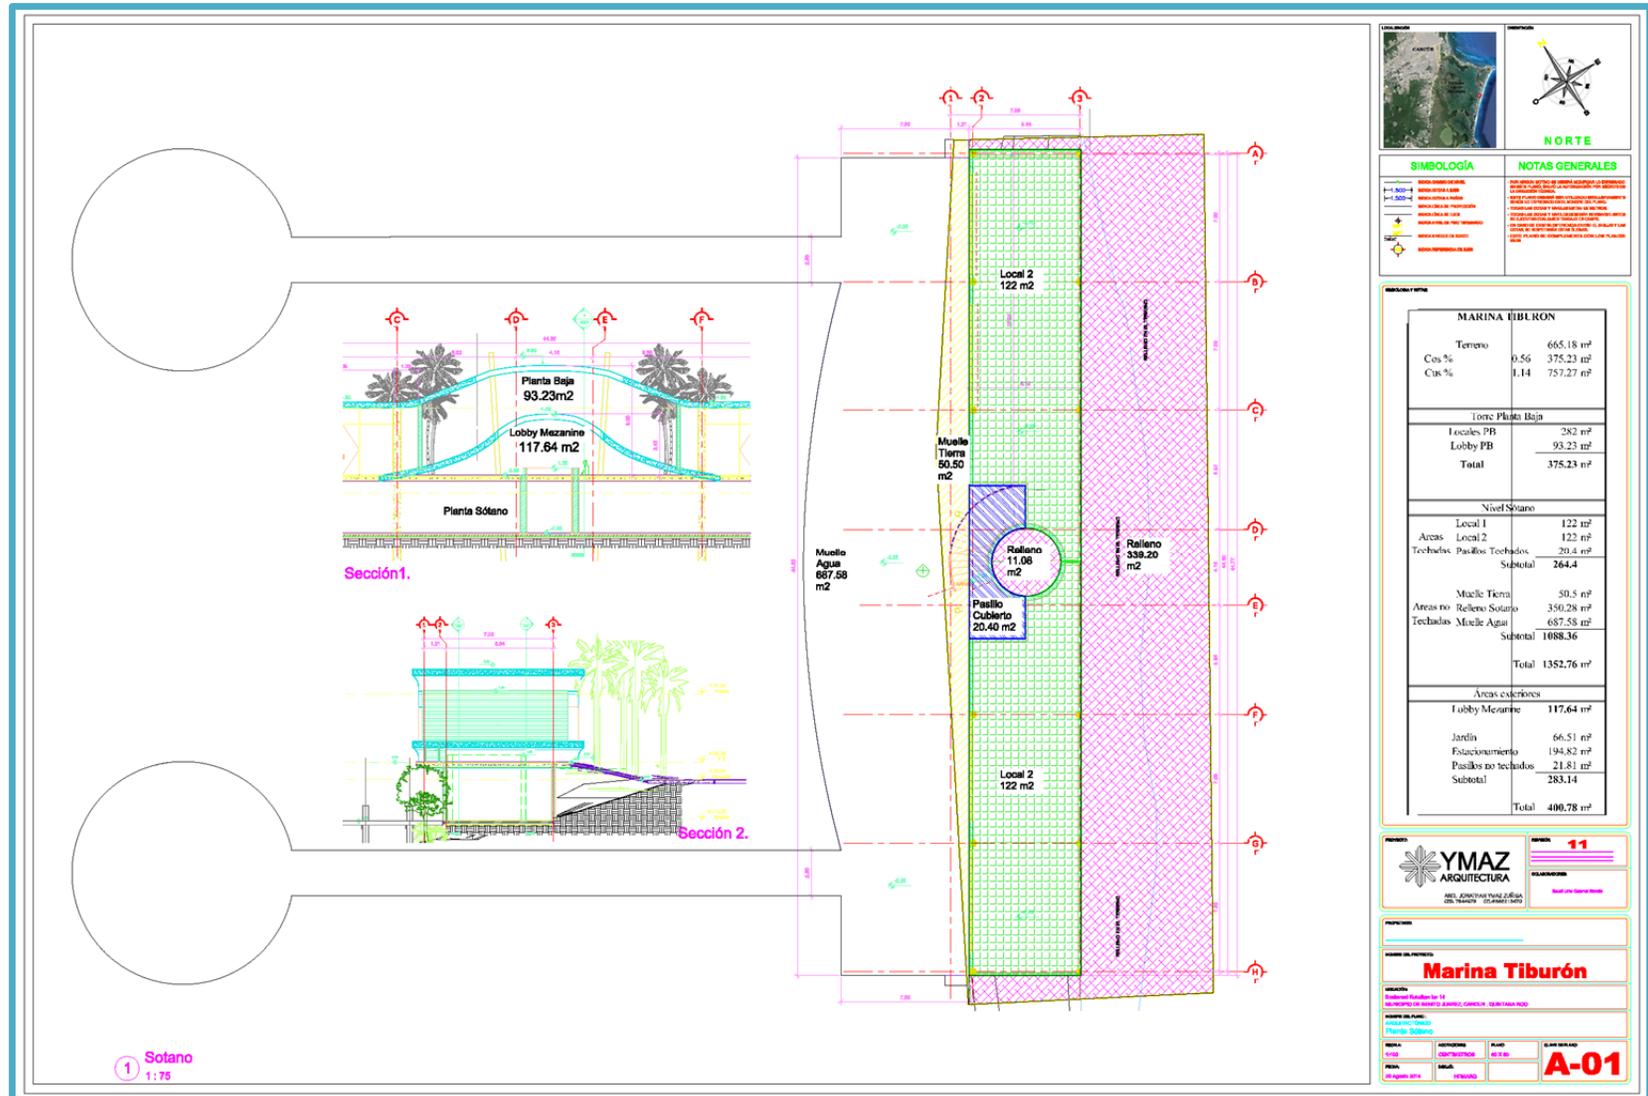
Plano arquitectónico planta sótano. Fuente: Imaz Arquitectura/2014.
